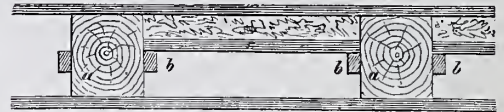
Balkendecke mit Quereinschub auf Laten.
